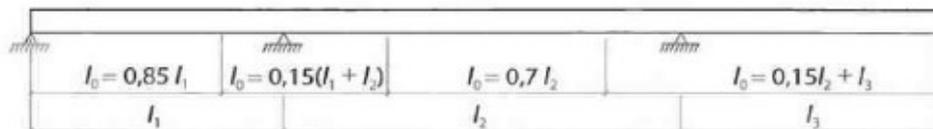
Определение расчетного (эквивалентного) поперечного сечения конструкций по СП РК EN «Бетонные и железобетонные конструкции»
